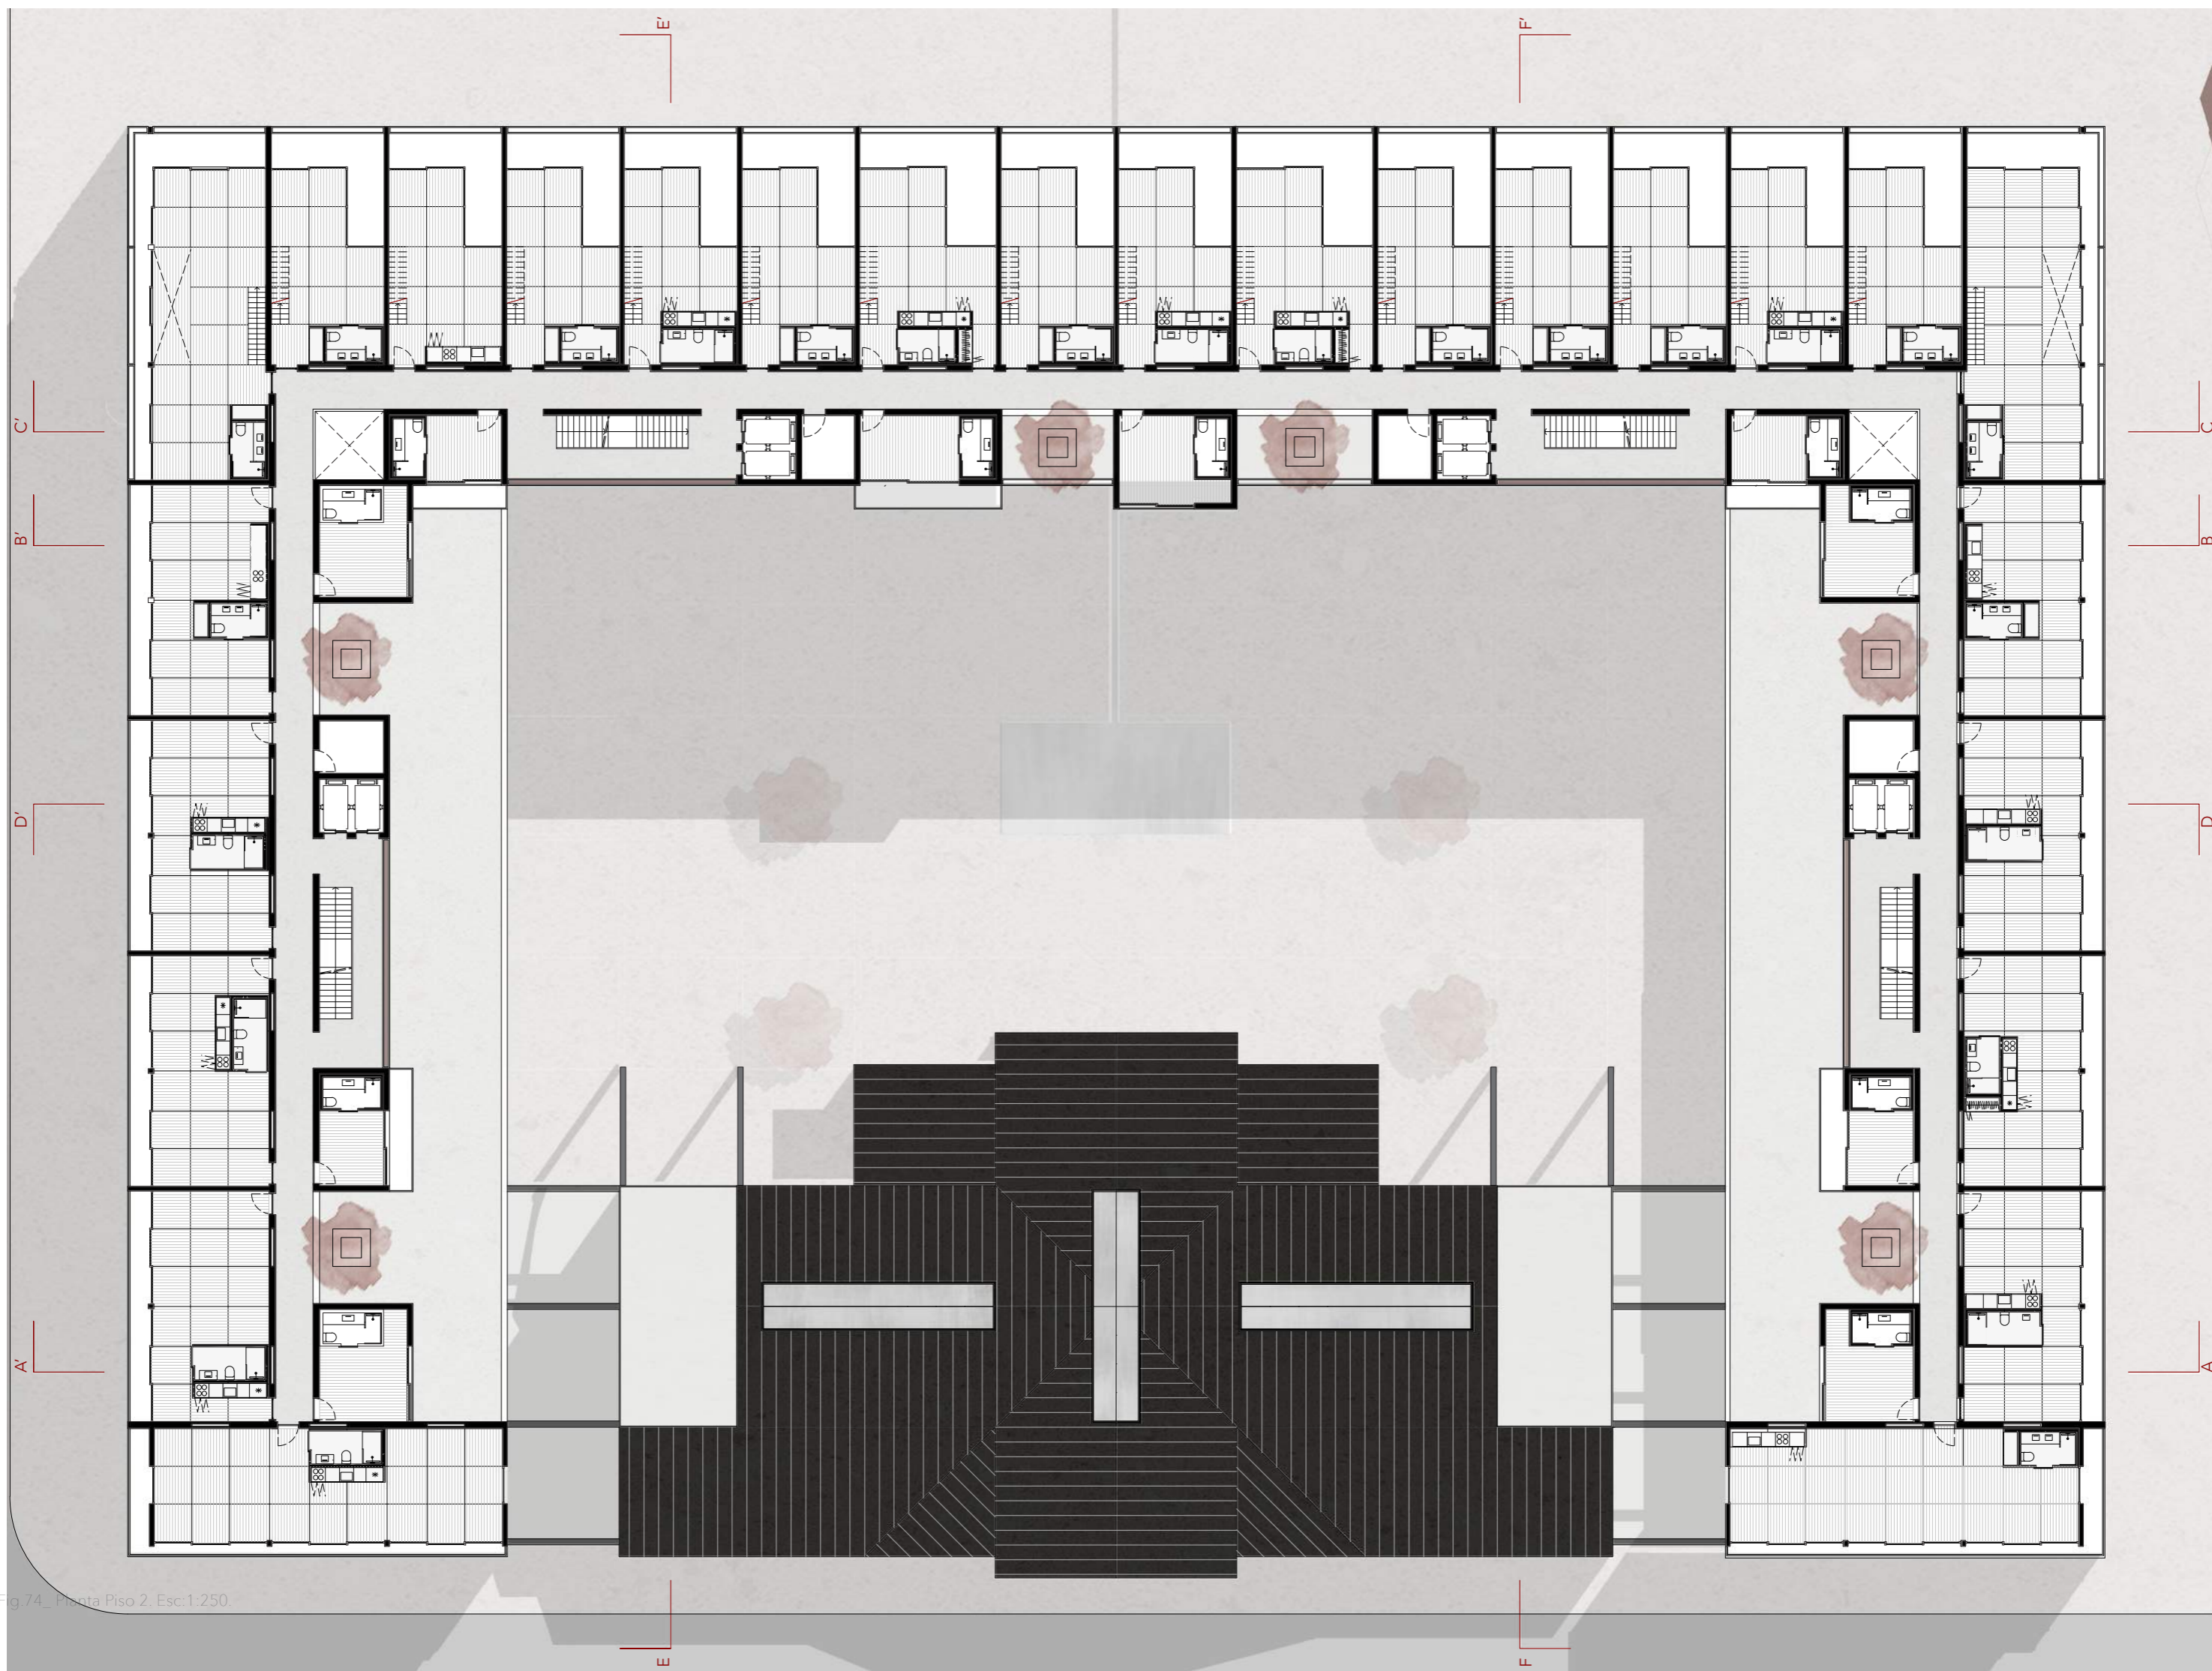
\_ Planta Piso 2. Esc: 1:250.
